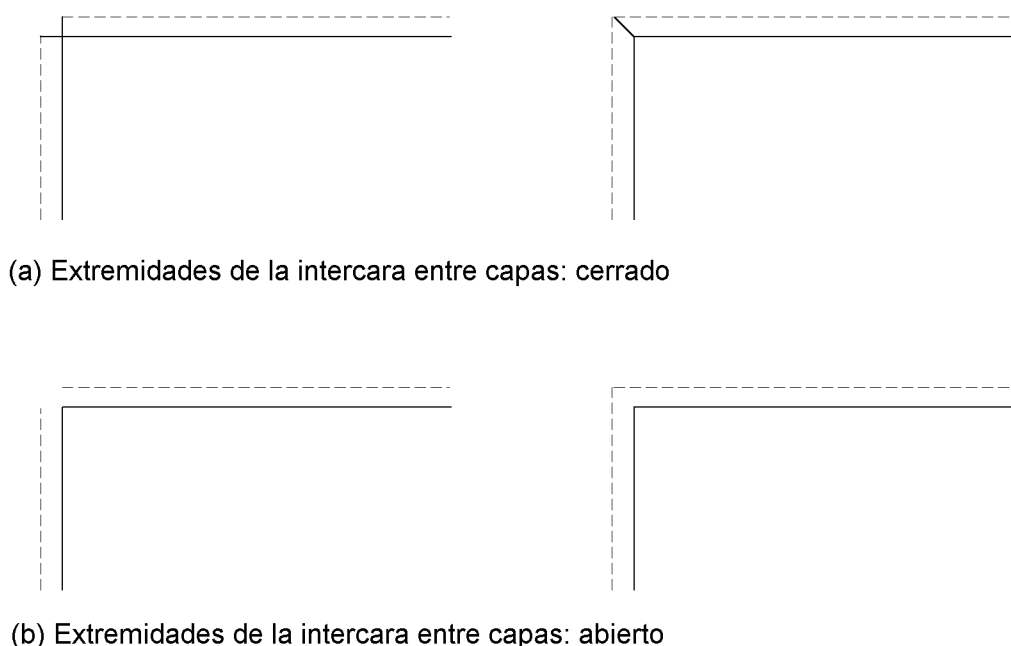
Detalles de esquina para muros con más de una capa
